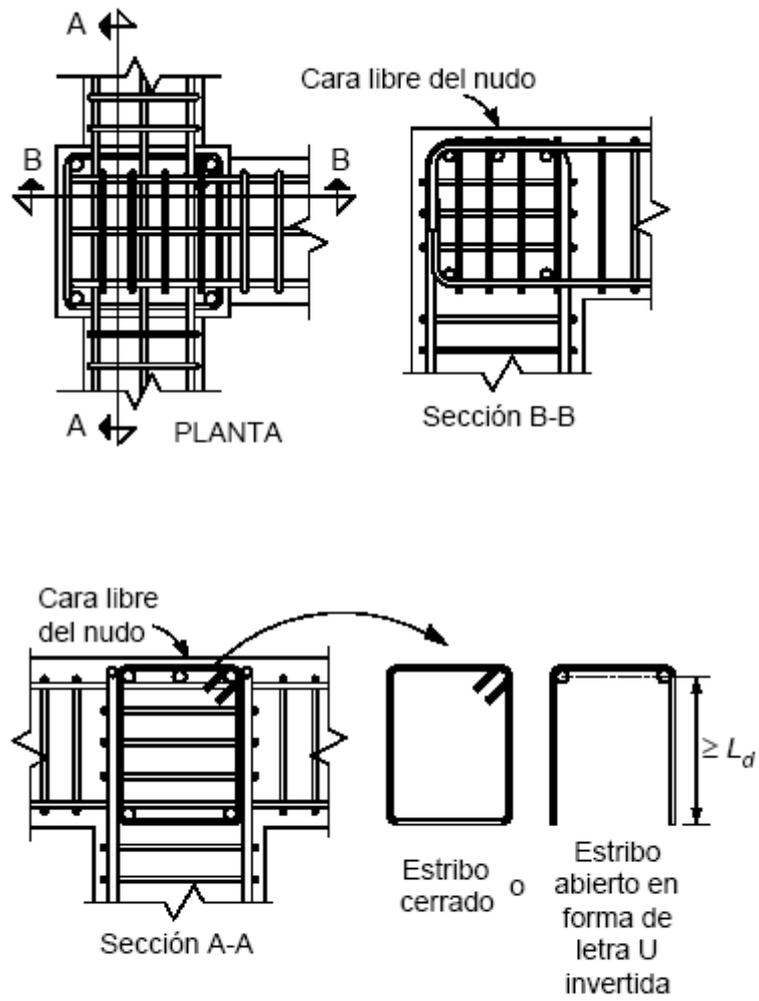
Refuerzo transversal vertical en uniones viga – columna
